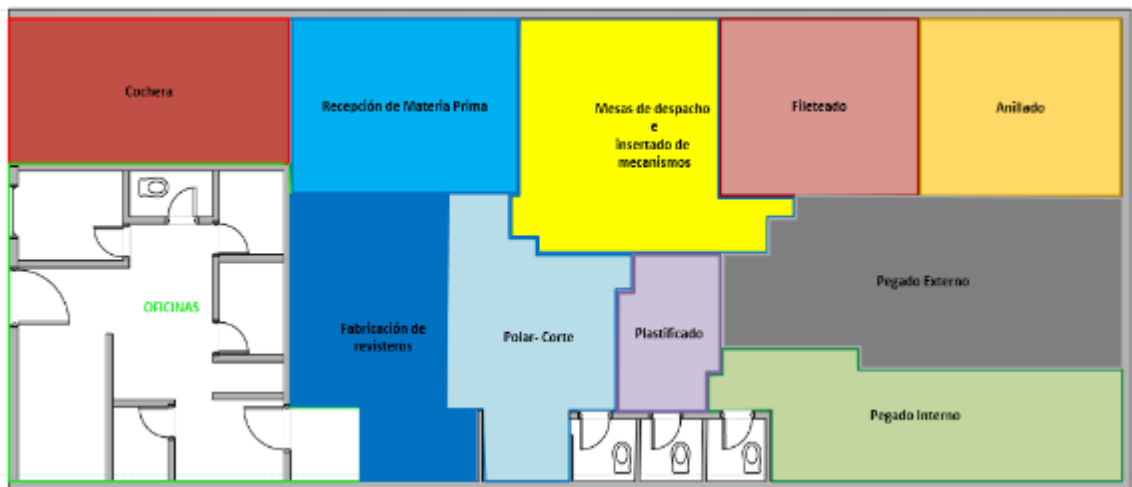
Diseño de distribución de planta en plano de la empresa Luxprint
